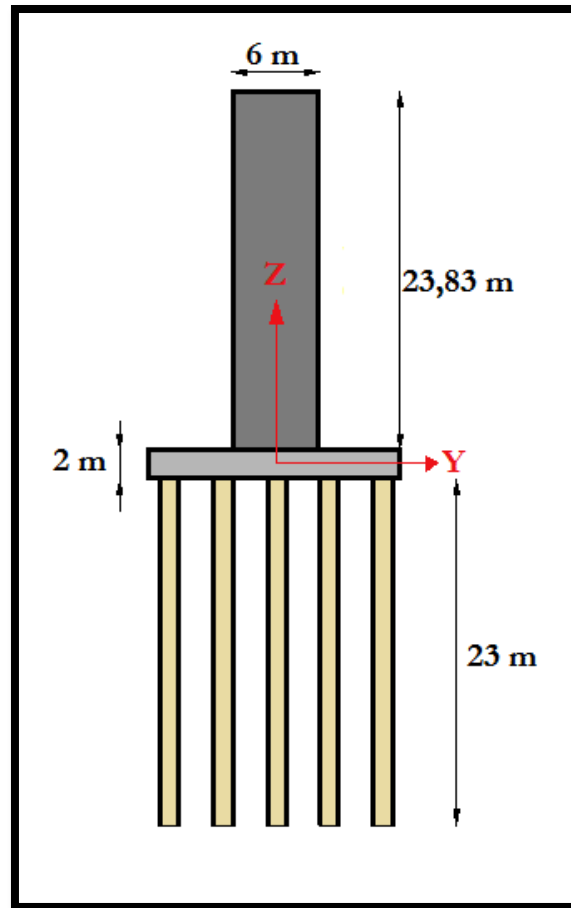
Coupe transversale (pile + semelle de liaison + pieux).
